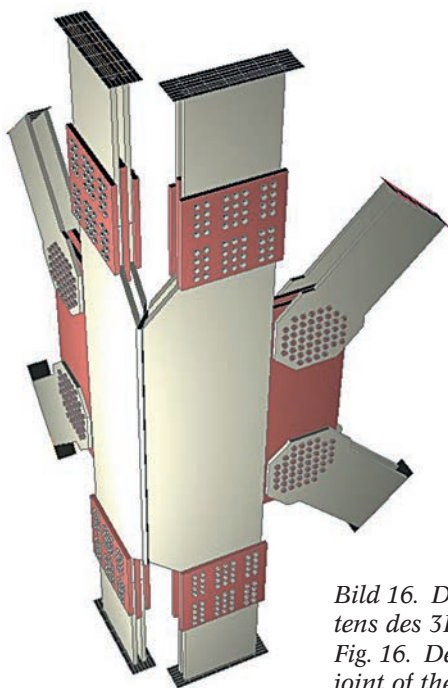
Detail eines Eckknotens des 3D-Stahlfachwerks
